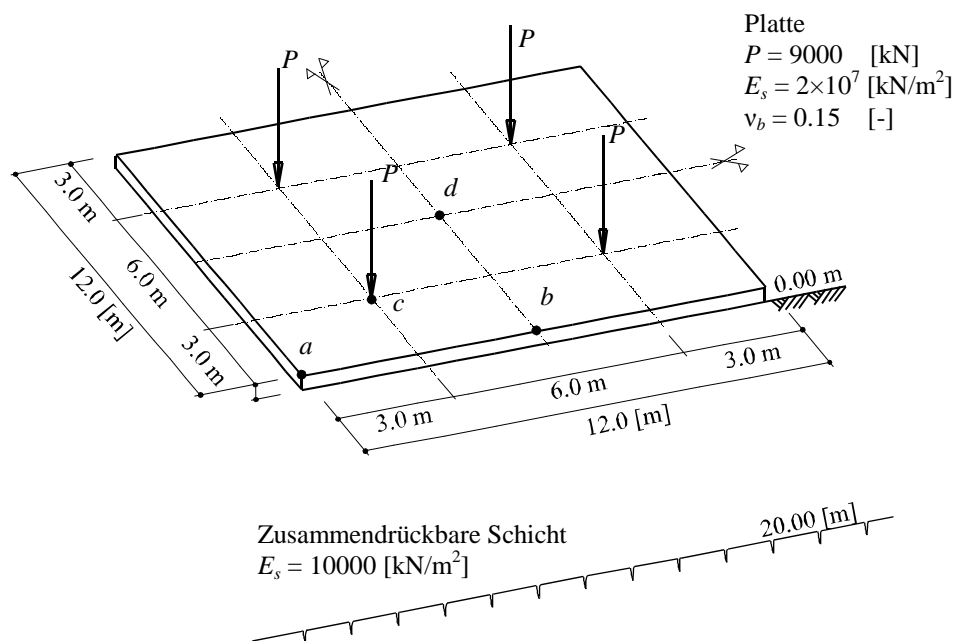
Abmessungen der Platte, Lasten und Baugrund
